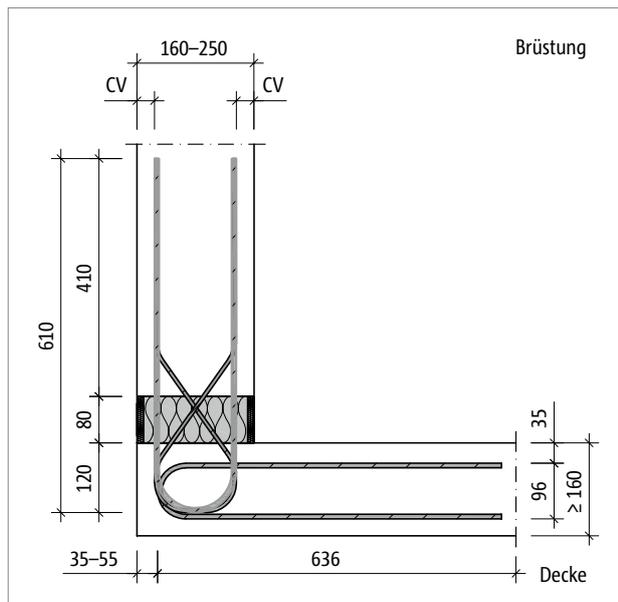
Schöck Isokorb® T Typ A-MM2-X80: Produktschnitt
